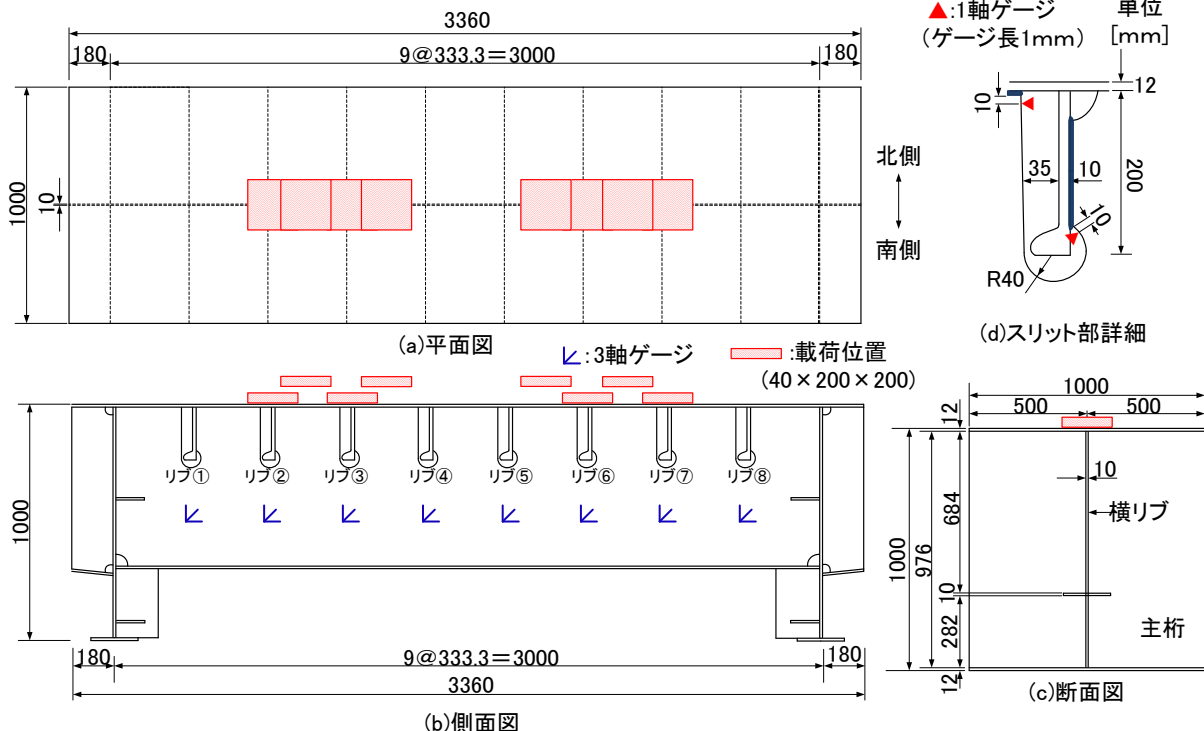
試験体の形状と寸法および荷重位置とひずみゲージ位置
